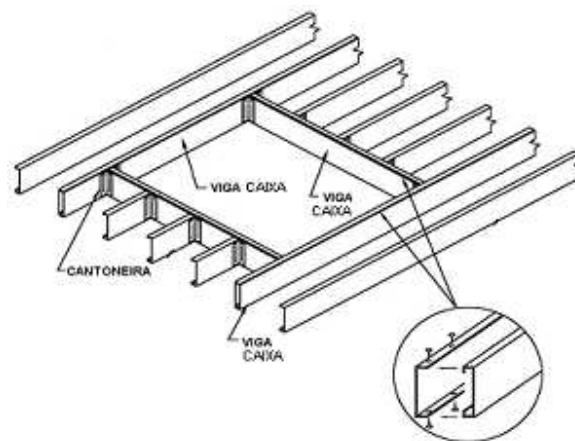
Viga caixa em painel externo paralelo à direção do vigamento (a) em um painel (b) em corte
